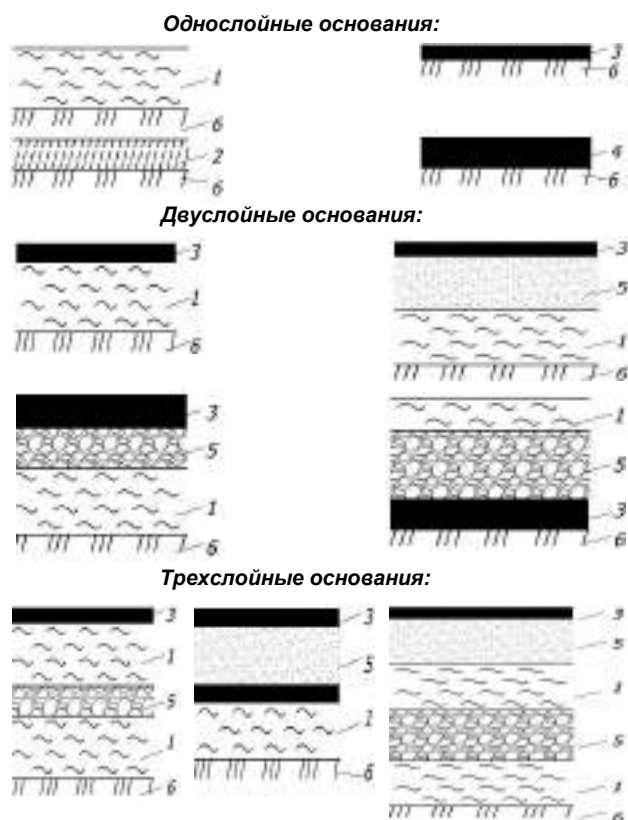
Типы оснований площадок выщелачивания: 1 – глина; 2 – бетон; 3 – геомембрана; 4 – асфальт; 5 – дренаж; 6 – грунтовое основание
